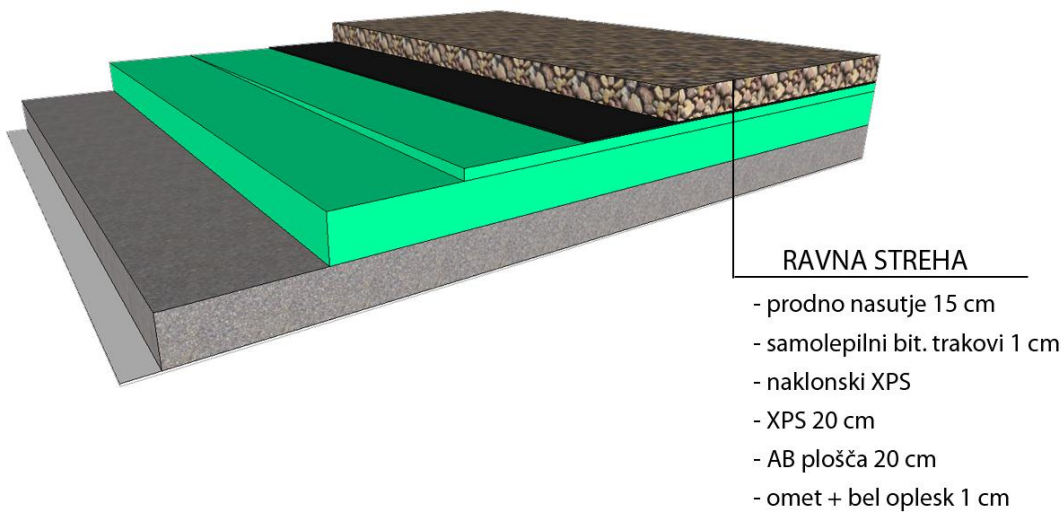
Geometrija uporabljenega modela (Primer št. 3)
